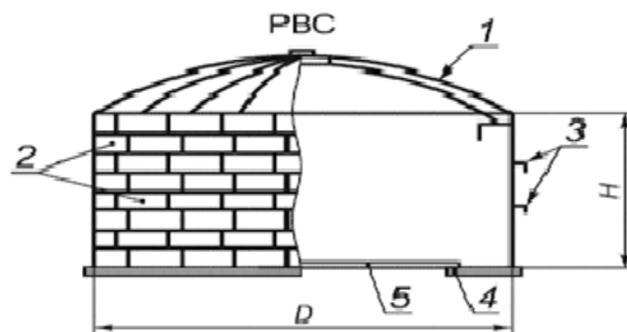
Основные элементы устройства резервуара РВС [3].
